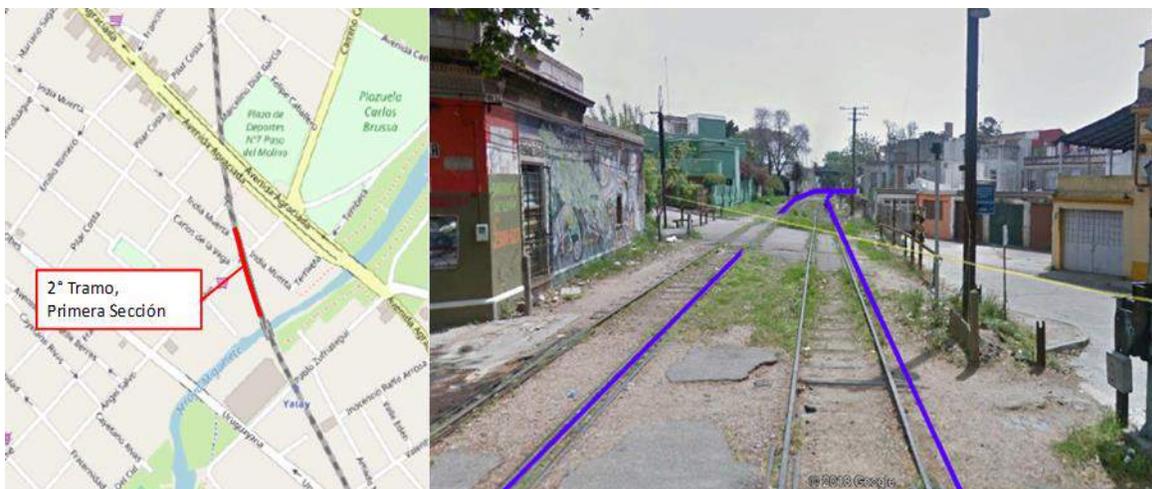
Segundo tramo, Primera sección: Casas y edificios sin afectación
